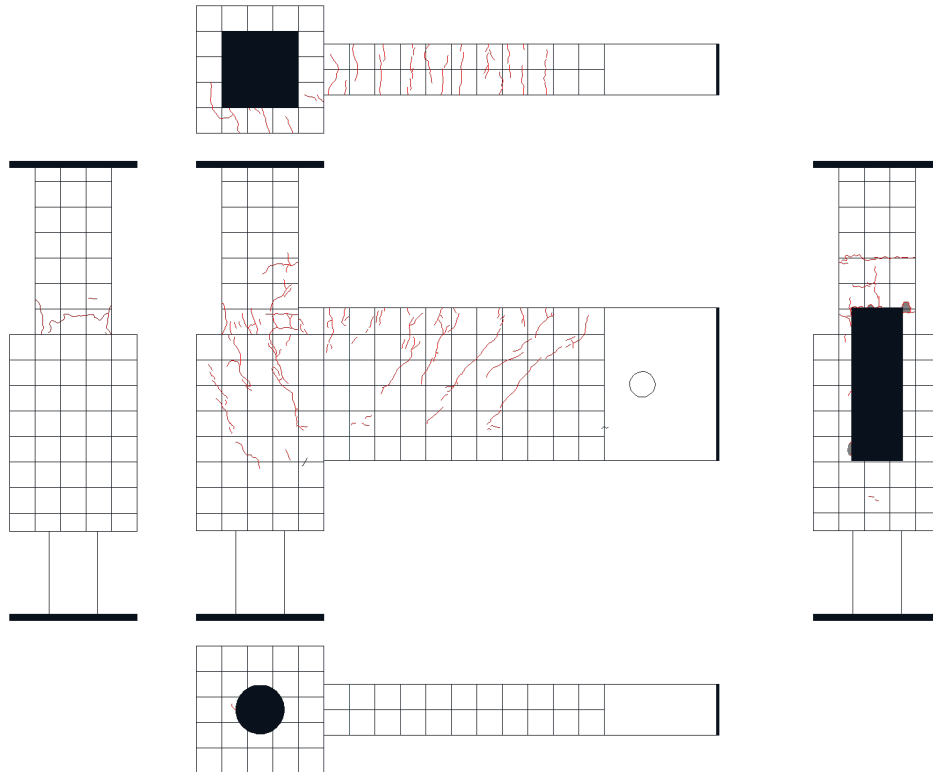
試験体 D-2 ひび割れ状況 (5Cycle)
